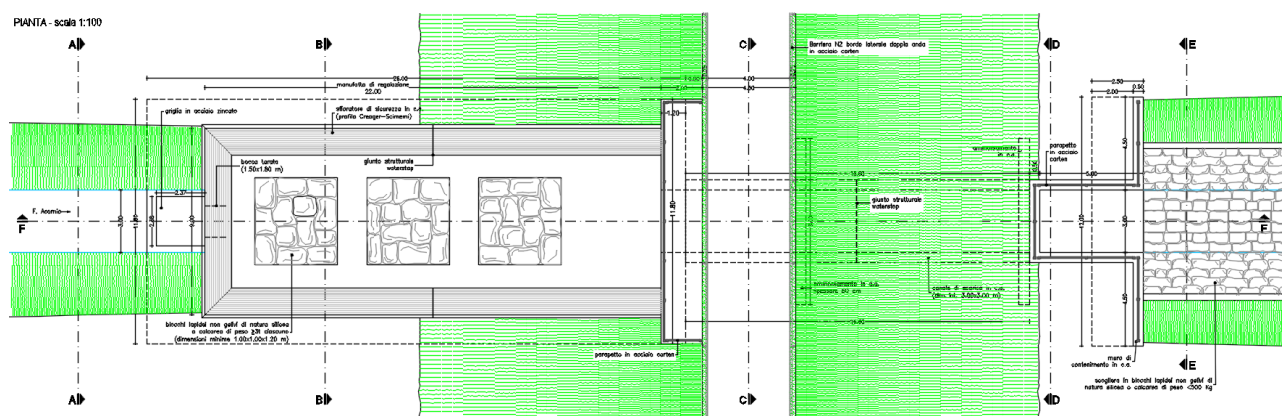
pianta del manufatto di regolazione a bocca tarata e del cunicolo di scarico.
